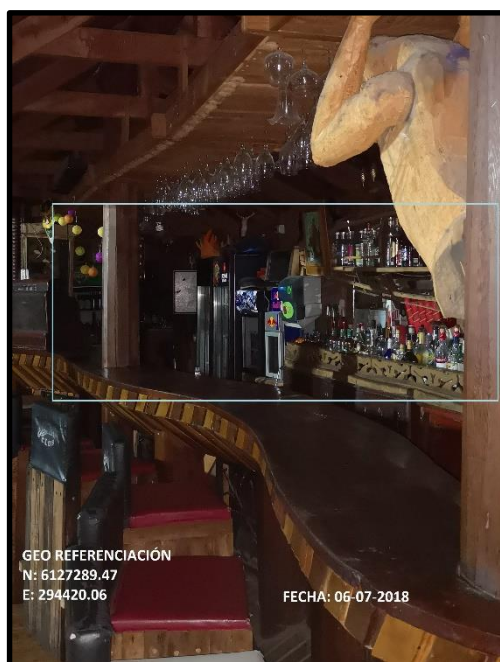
“Fachada Laterales del Bar Antes de ser Intervenido”.
